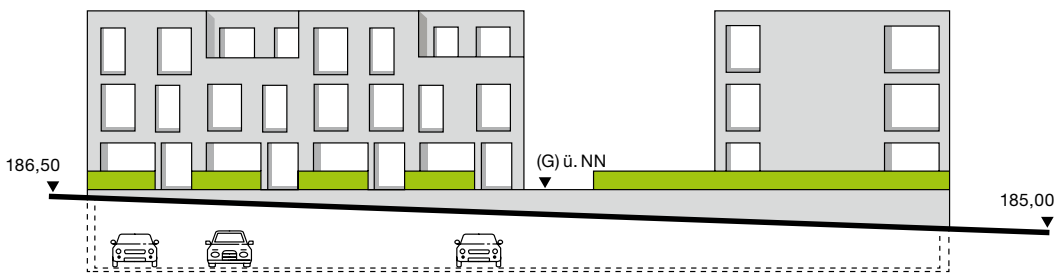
Systemschnitt Bebauung entlang Grüner Mitte
